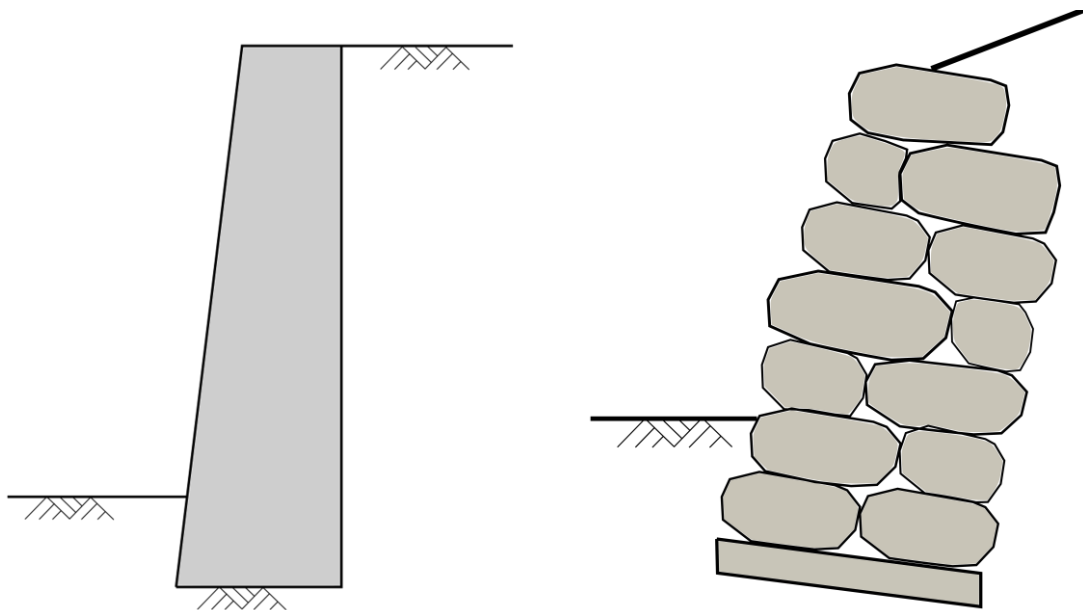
Links – Querschnitt einer Gewichtsmauer aus Beton; Rechts – Querschnitt einer Gewichtsmauer aus Steinblöcken
